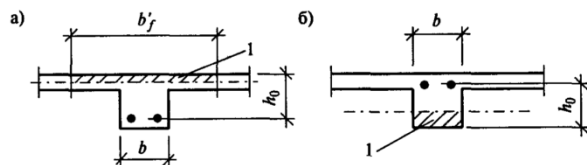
Расчетные сечения балок: а) в пролете (тавровое);
